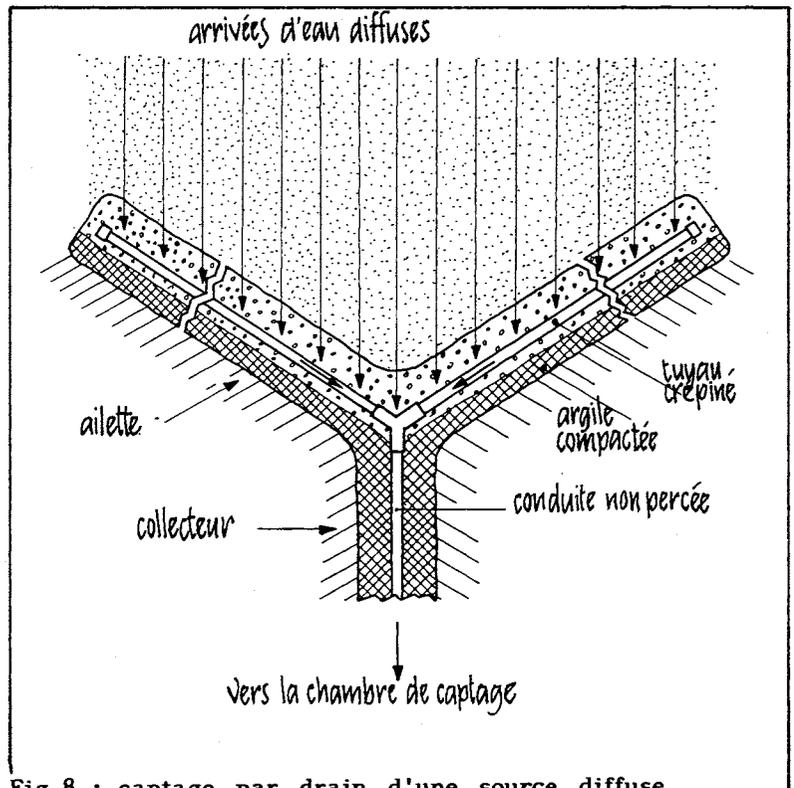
captage par drain d'une source diffuse (vue en plan).
